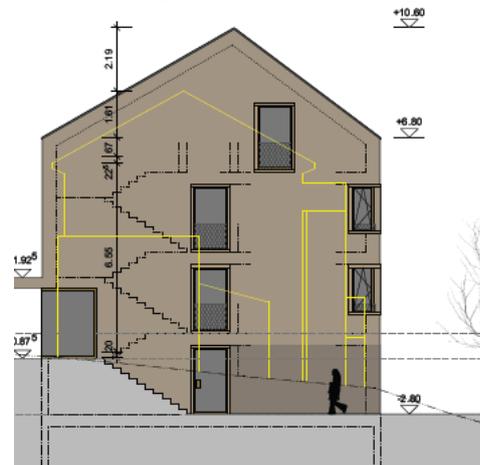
Flaches Grundstück unter 5 Grad Neigung, Gebäude mit Wohnfläche im UG
